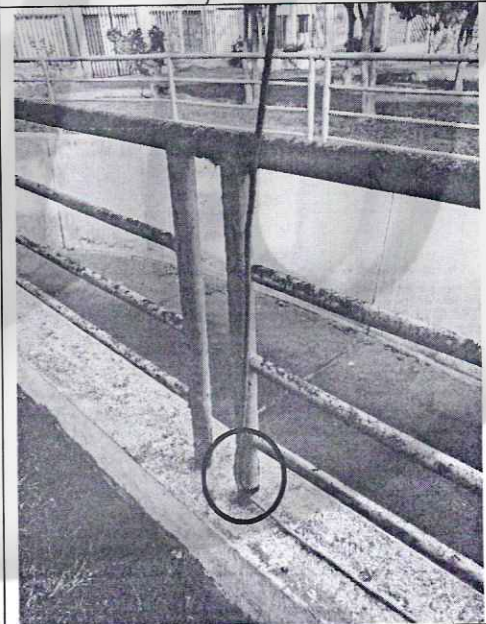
Cable de energía esta sujetado con cinta aislante.
